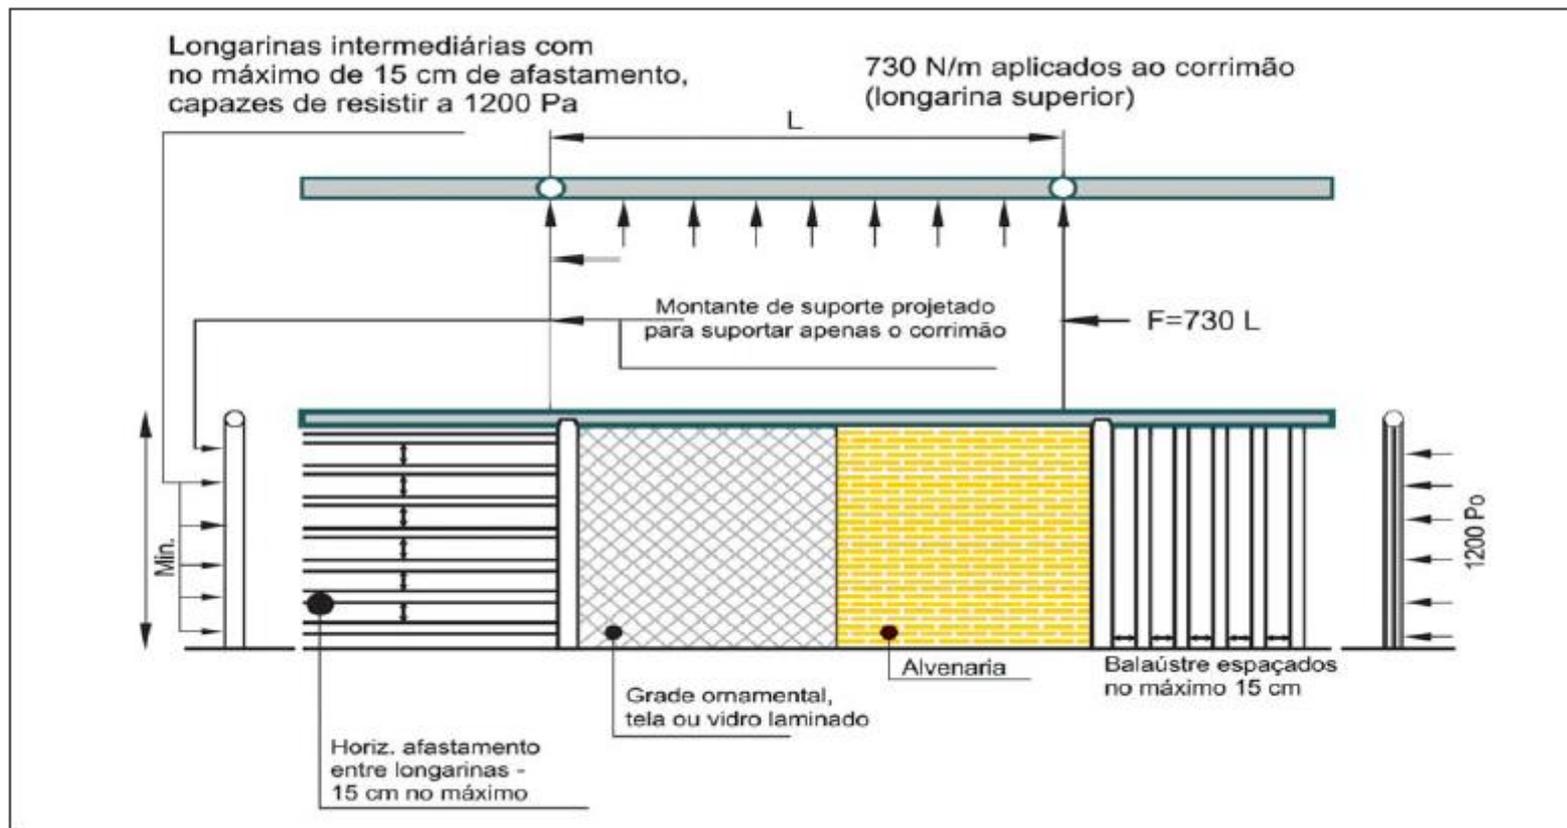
Pormenores construtivos da instalação de guardas e as cargas a que elas devem resistir
